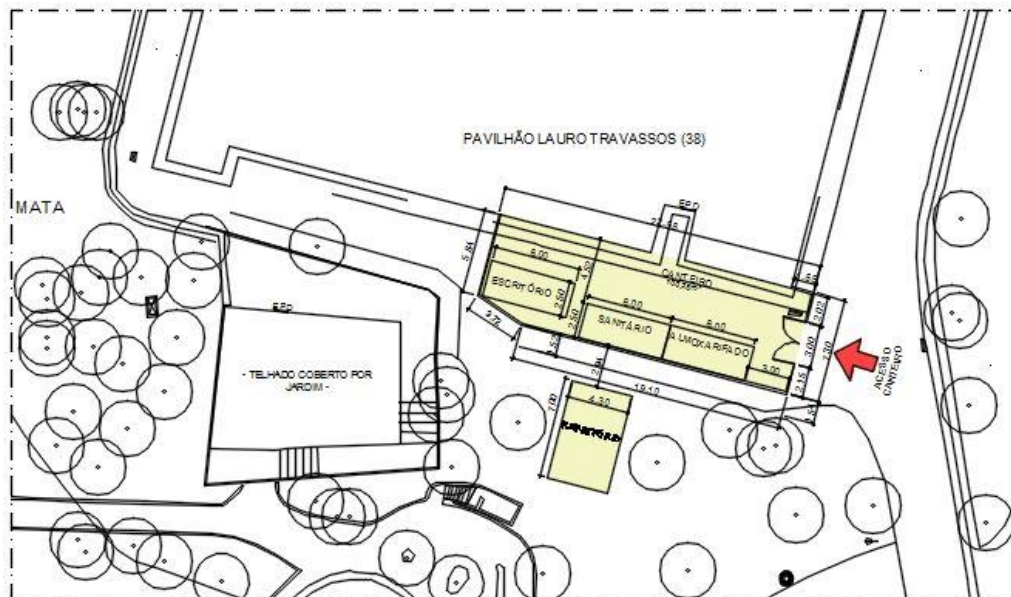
Implantação estruturas auxiliares Canteiro de obra – LAFICAVE.
